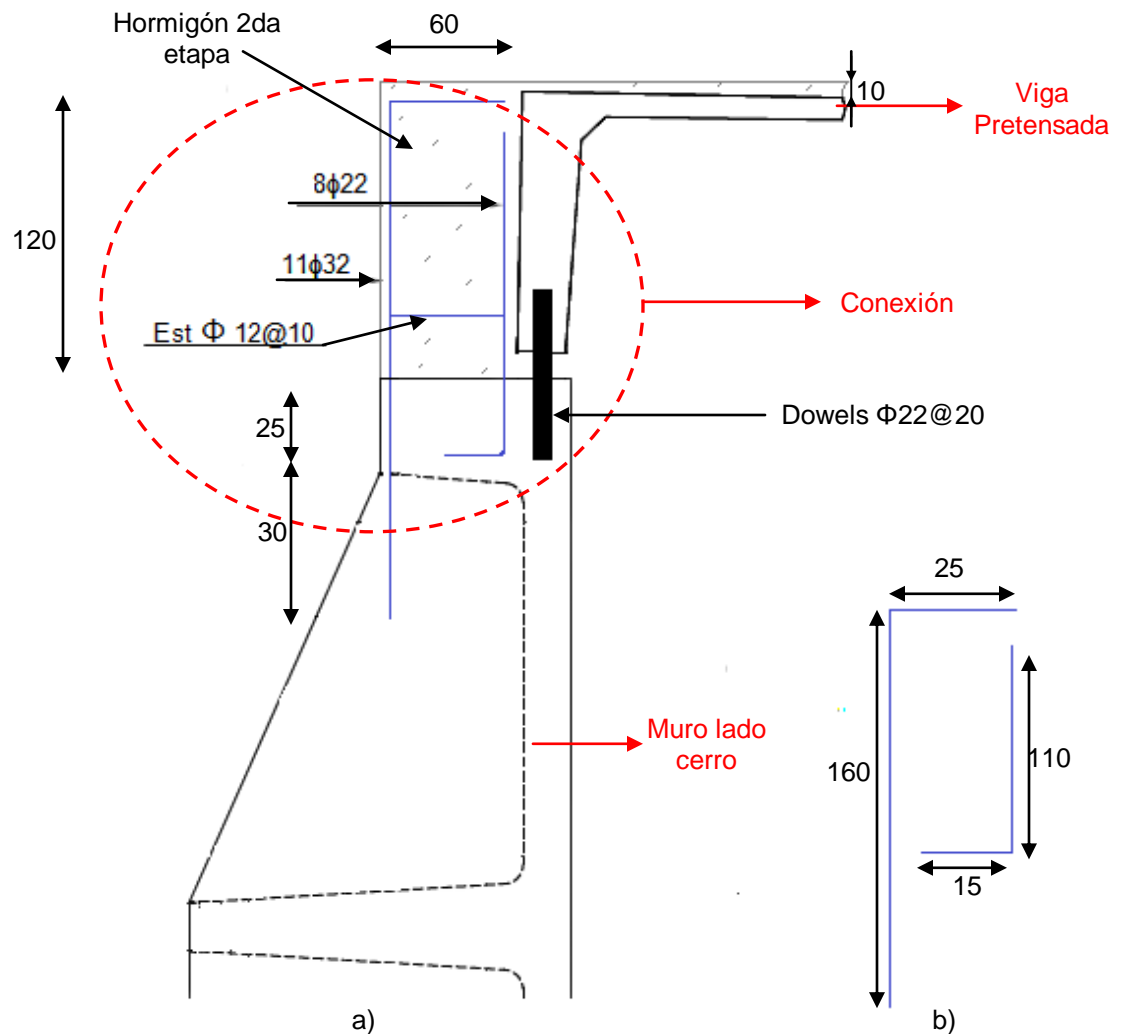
a) Unión entre la viga y el muro lado cerro. b) Dimensiones armadura.
